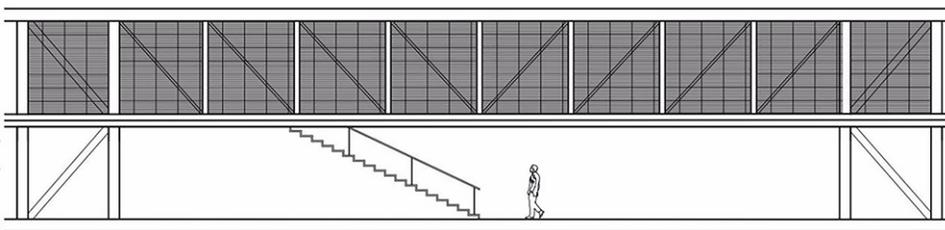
Picture Window House - Elevación frontal. Elaboración: Shigeru Ban Architects
